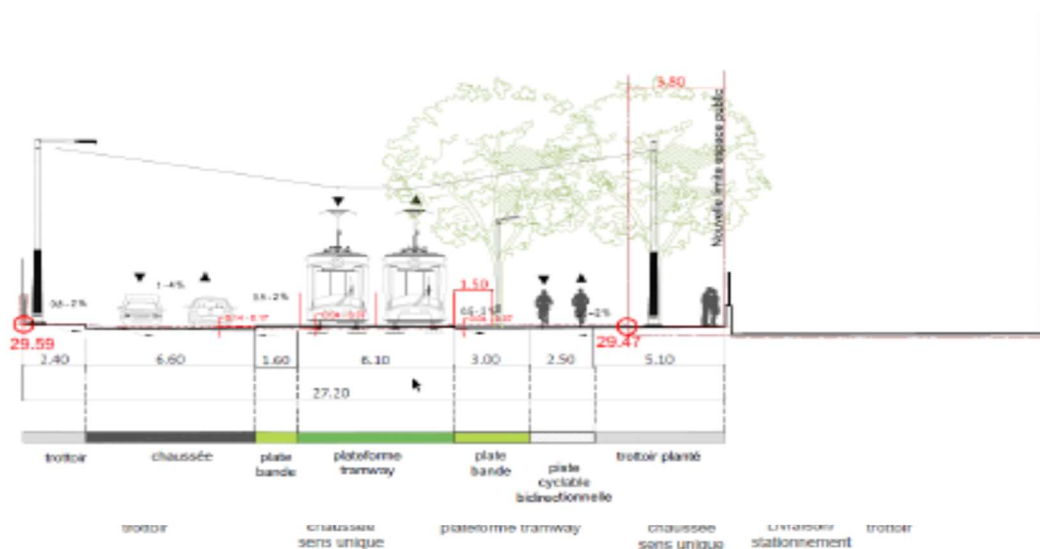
Profil en travers de la rue de Lyon (coupe 7)
